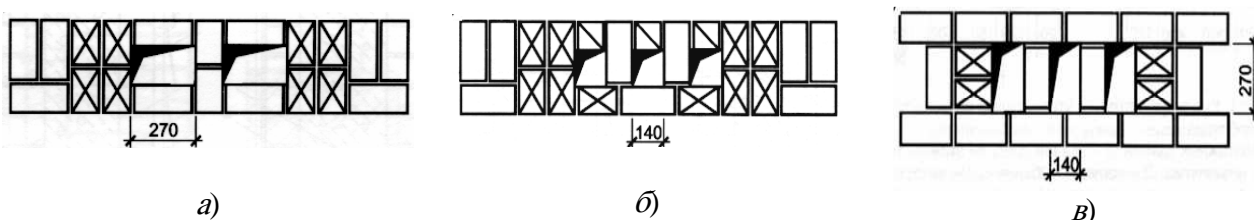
Вентиляционные каналы в кирпичных стенах:
